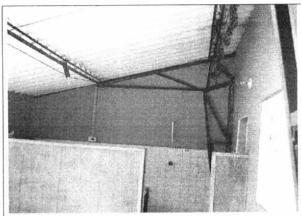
Vista interior del inmueble, sin daños estructurales apreciables. Sector de cafetería.
